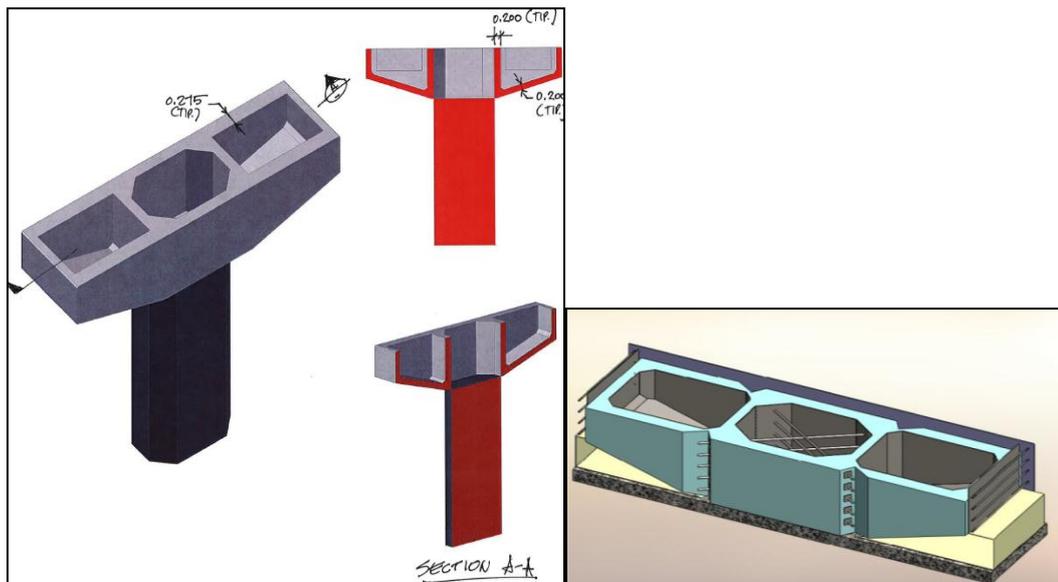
Imagen en 3D del primer modelo para viga cabezal.
